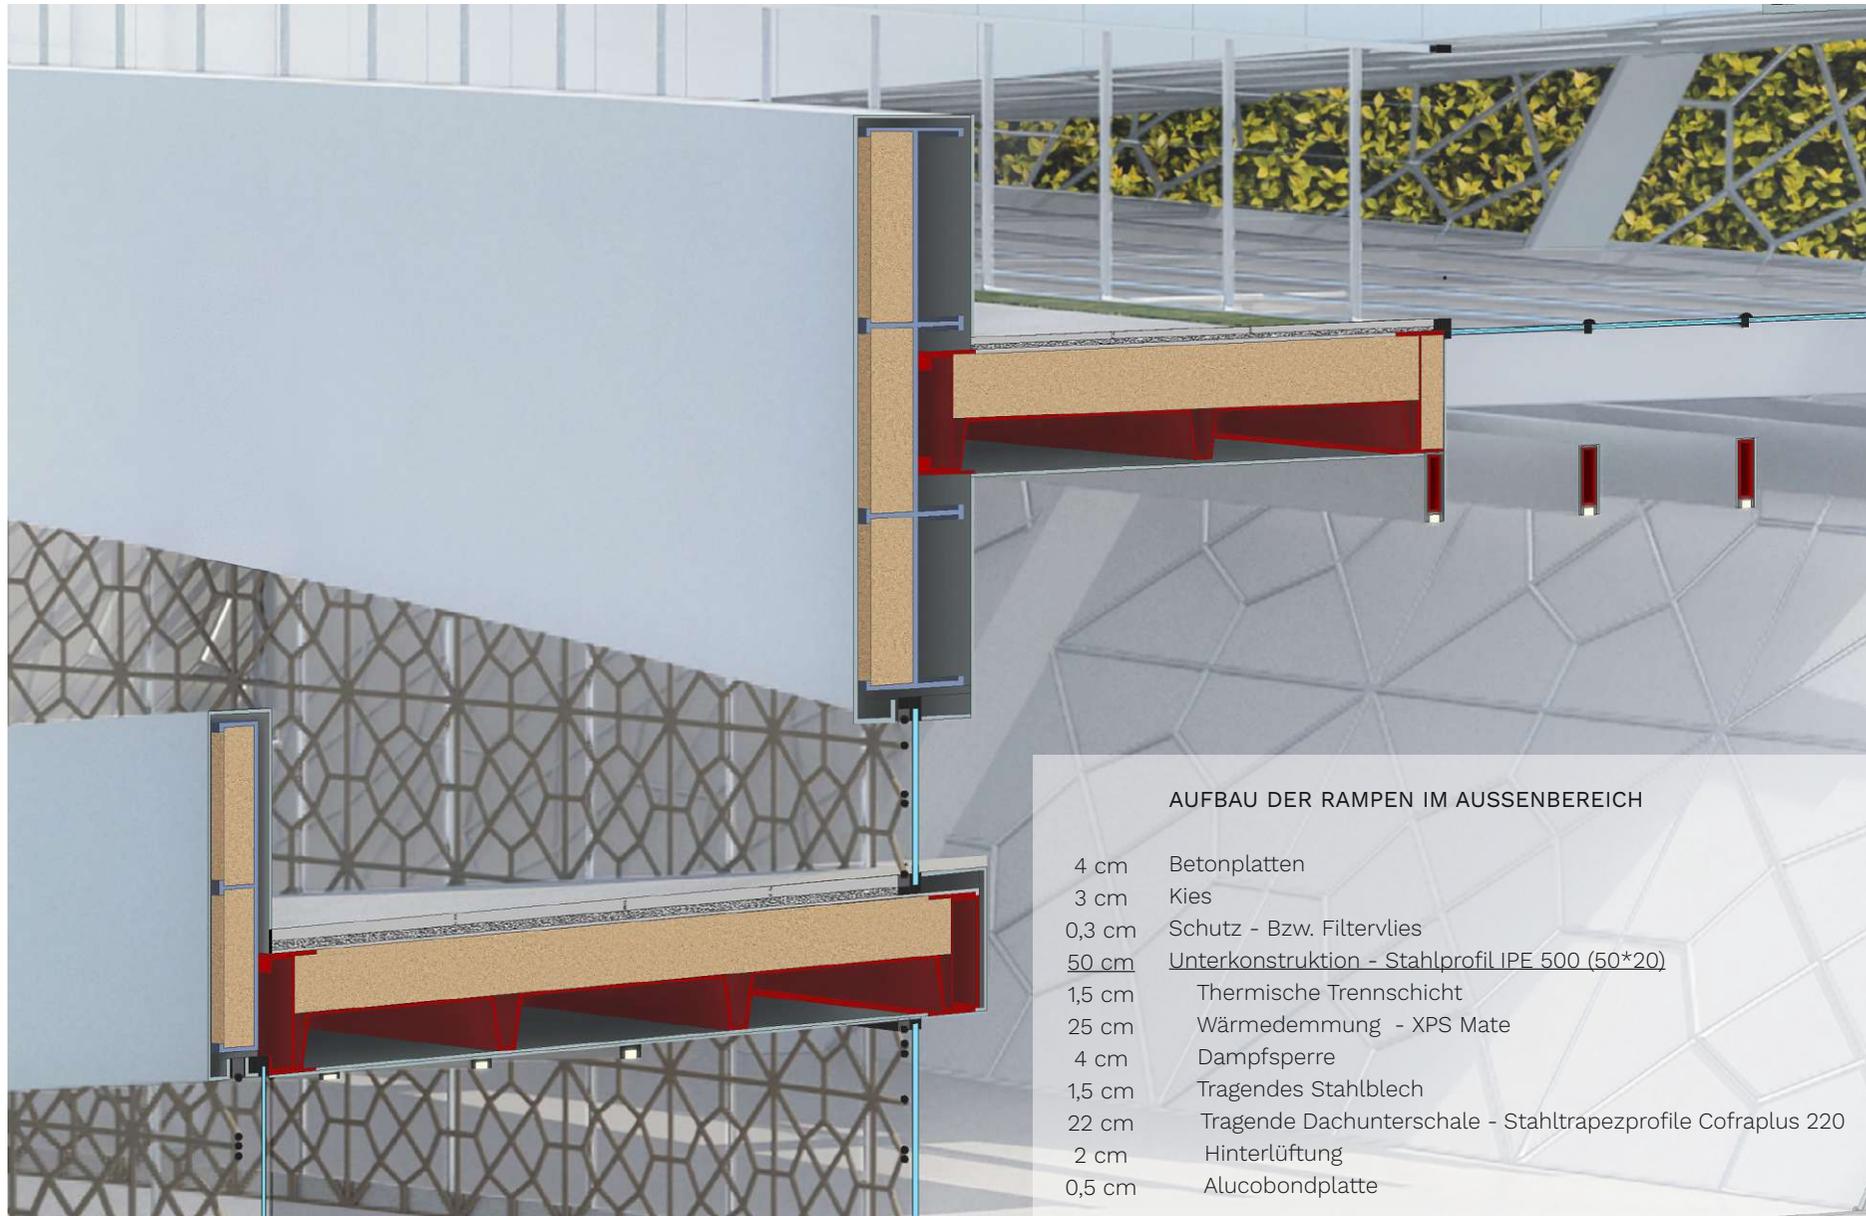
3d Fassadenschnitt. Detail 1.1
